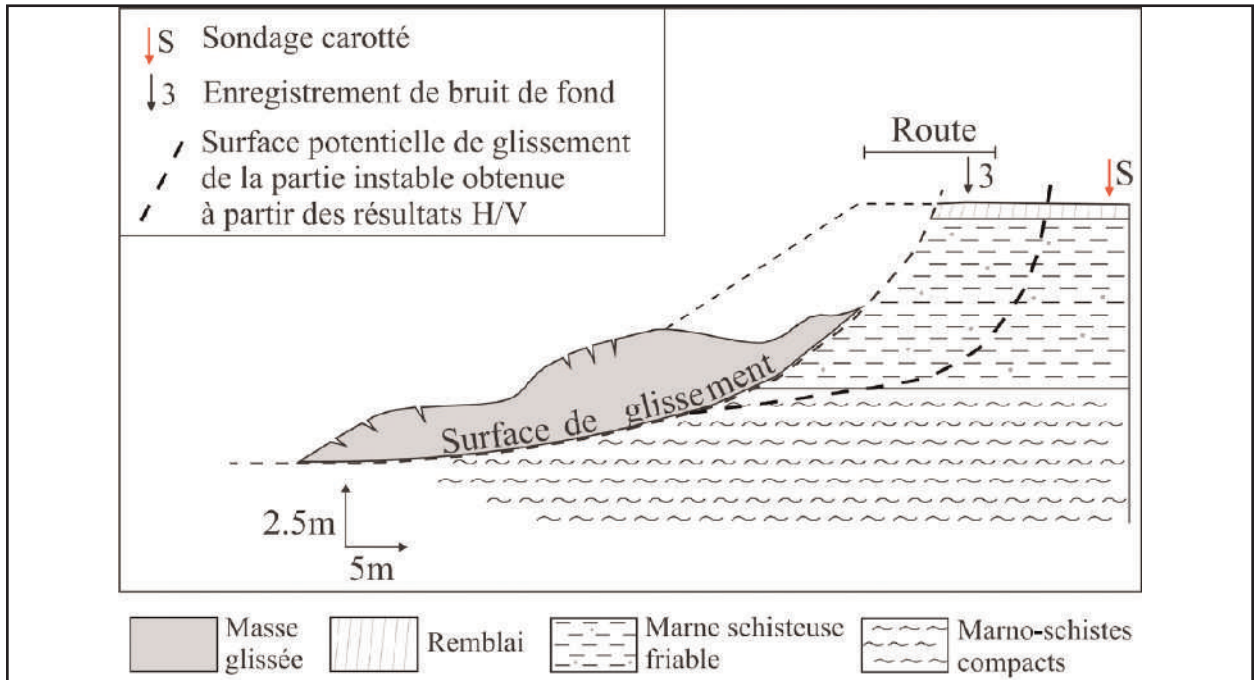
Coupe transversale est-ouest à travers le sondage carotté, l'enregistrement de bruit de fond n°3 et le glissement.
